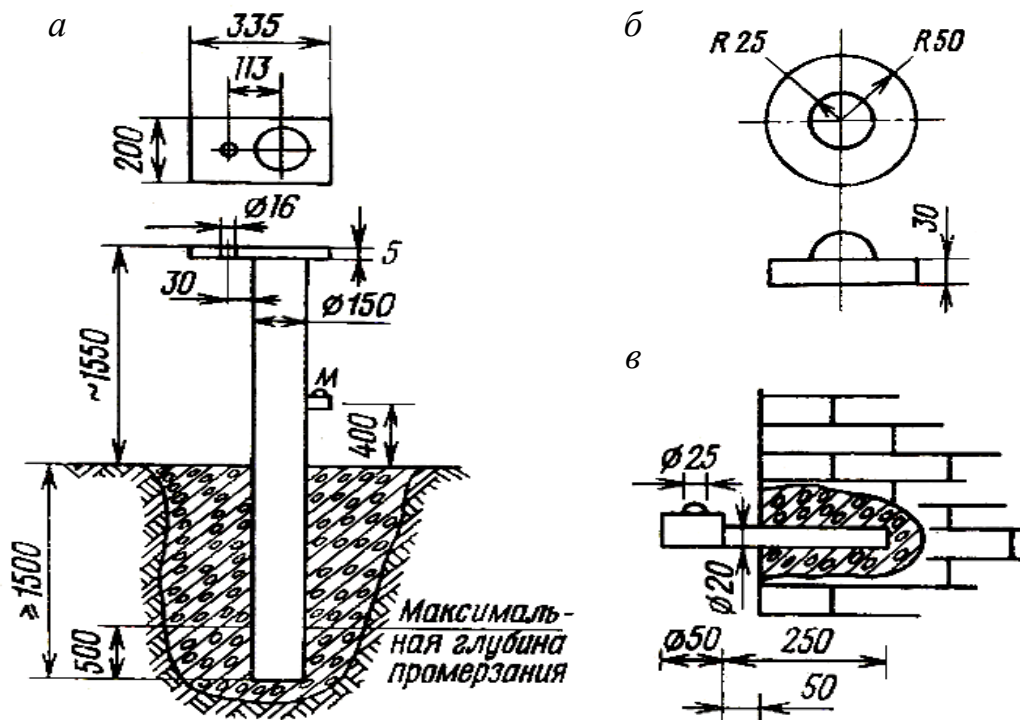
Конструкция опорного знака (а), осадочной марки (б) и стенного репера (в)
